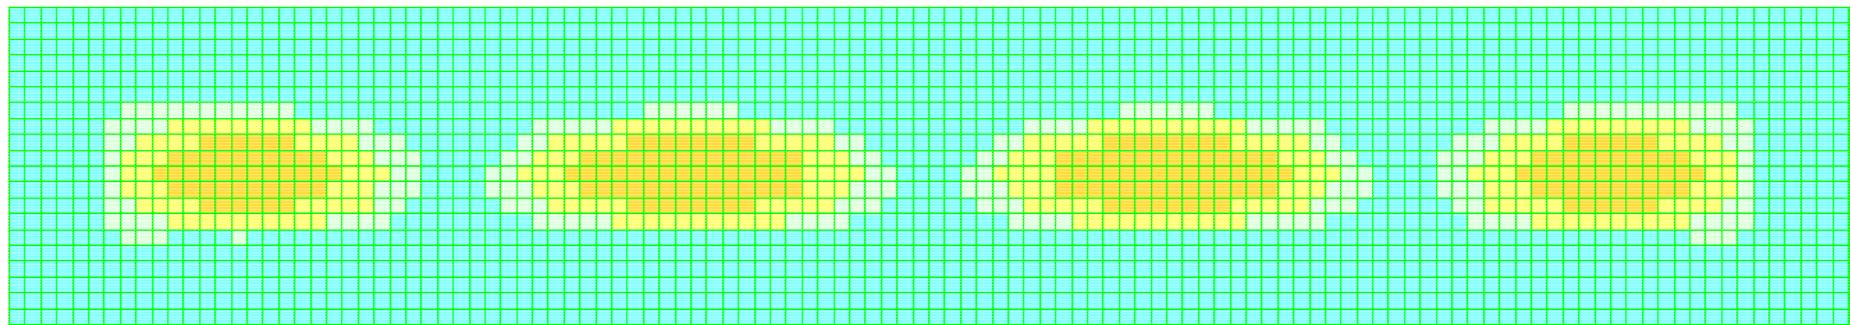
б. Вертикальное армирование стен вдоль цифровых осей (нижняя грань Y).
